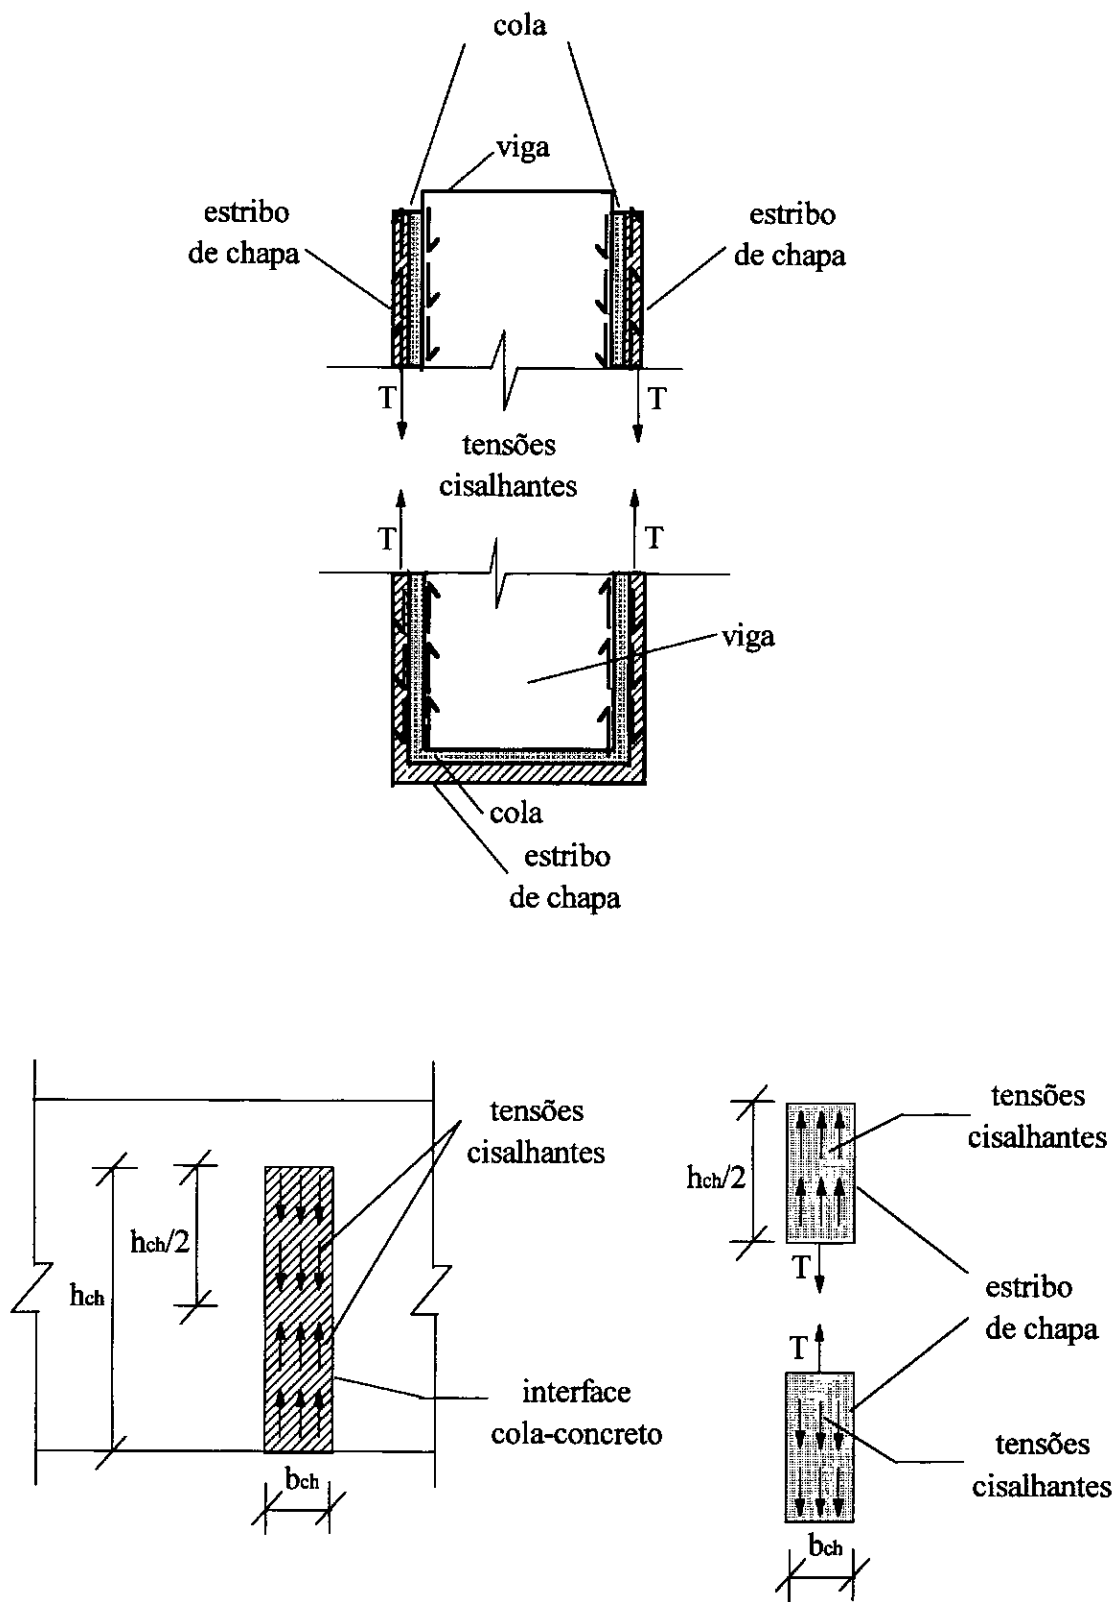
Distribuição de tensões cisalhantes na ligação estribo de chapa- concreto-cola
